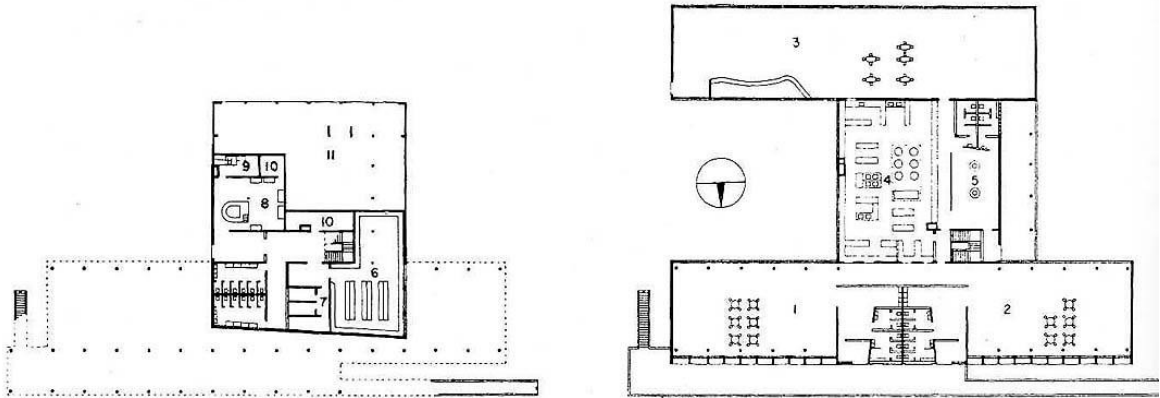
Pav. Carlos Augusto da Silva: planta baixa dos pavimento inferior, 1948. Fonte: MINDLIN, 2000
